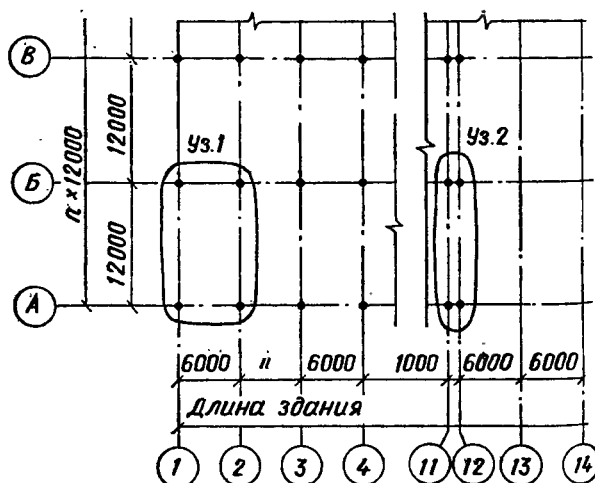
Схематический план (сетка разбивочных осей) многоэтажных зданий по серии 1.420-6; узлы 1 и 2 см. рис. 1.6.
